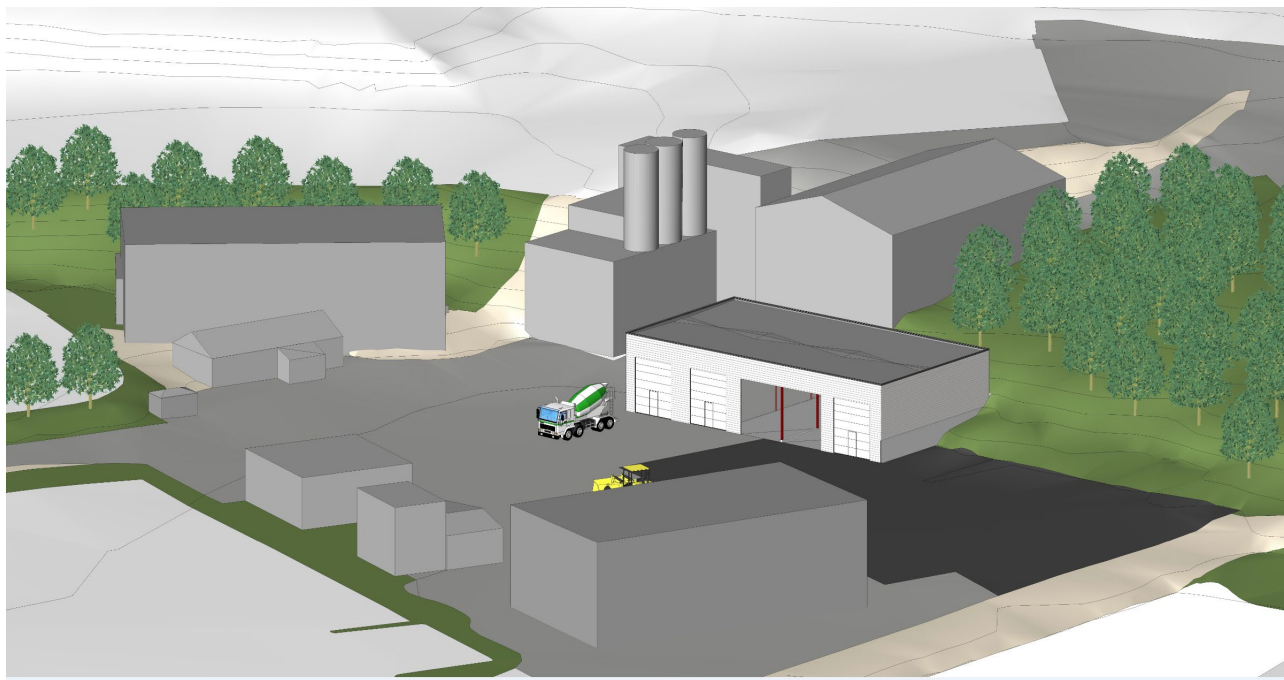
Illustrasjon planlagt ny bebyggelse - slambasseng med overbygg.
